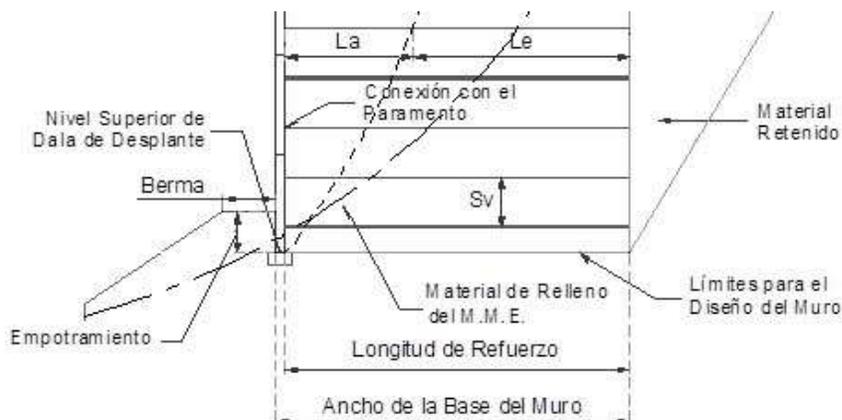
Talud y escalón de un Muro Mecánicamente Estabilizado
